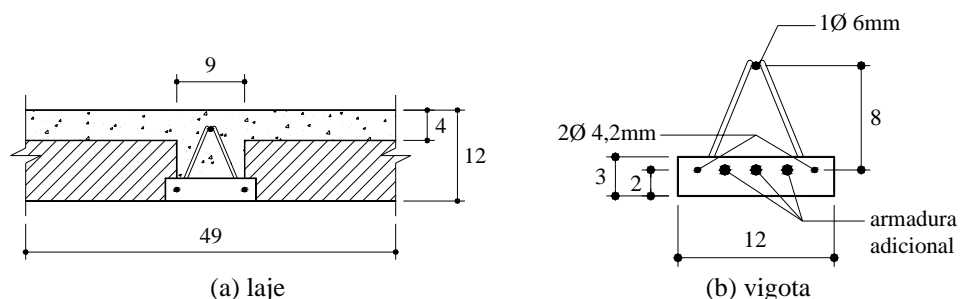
Seção transversal da laje com vão pequeno (dimensões em cm)
